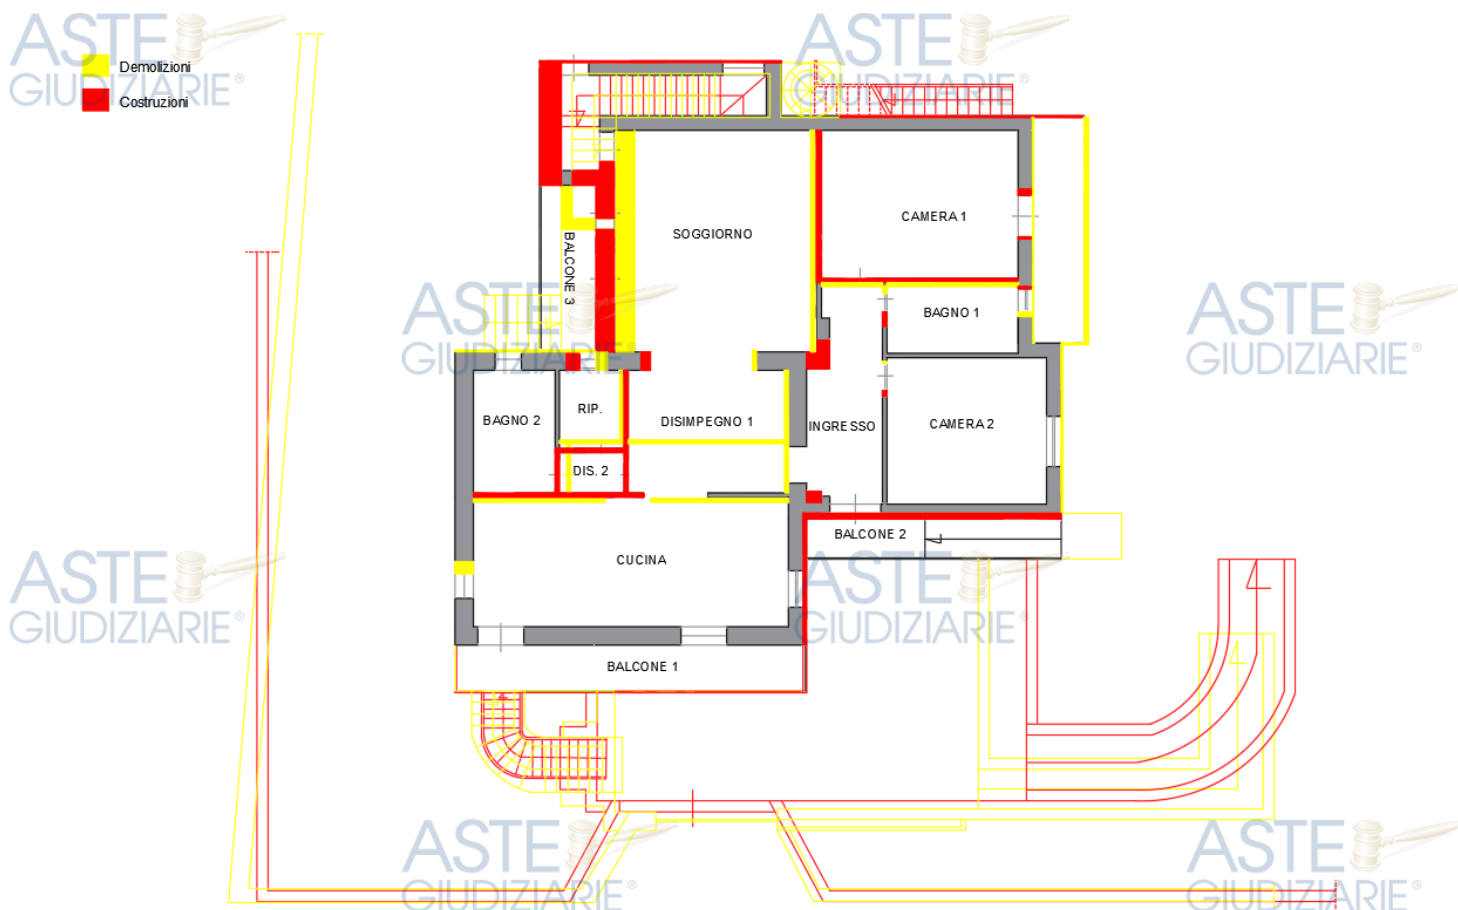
Confronto edilizio con C.E. n. 6/bis/2000 – pianta piano terra
